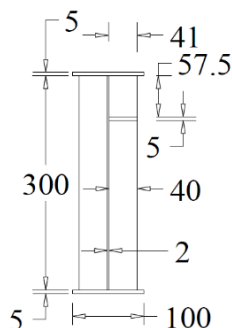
Secção transversal das vigas do Ensaio 1 [dimensões em mm] [10]
